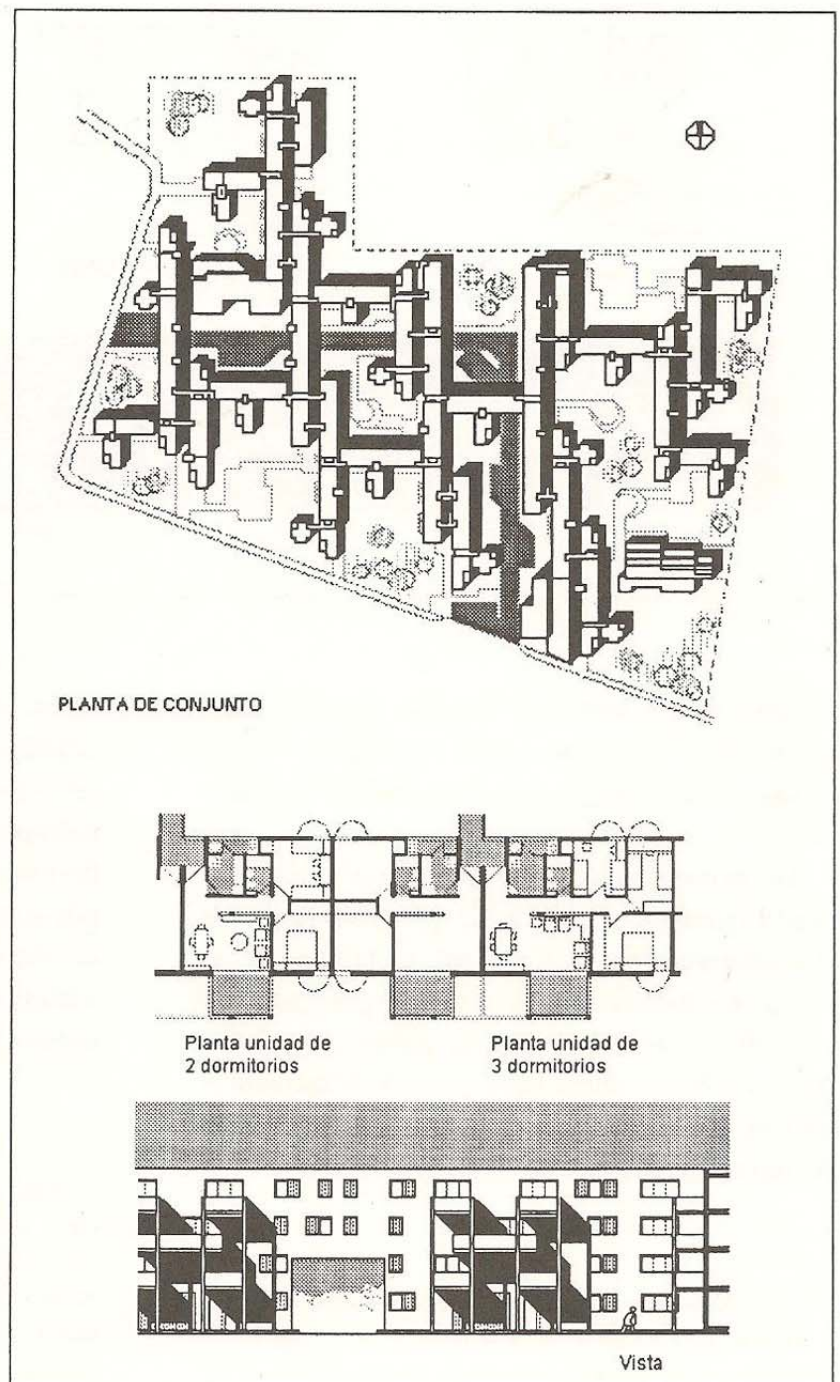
Conjunto La Matanza, del estudio Staff (Bielus, Goldemberg y Wainstein-Krasuk). Planta de conjunto, plantas de las unidades de 2 y 3 dormitorios, y elevación de un sector.
